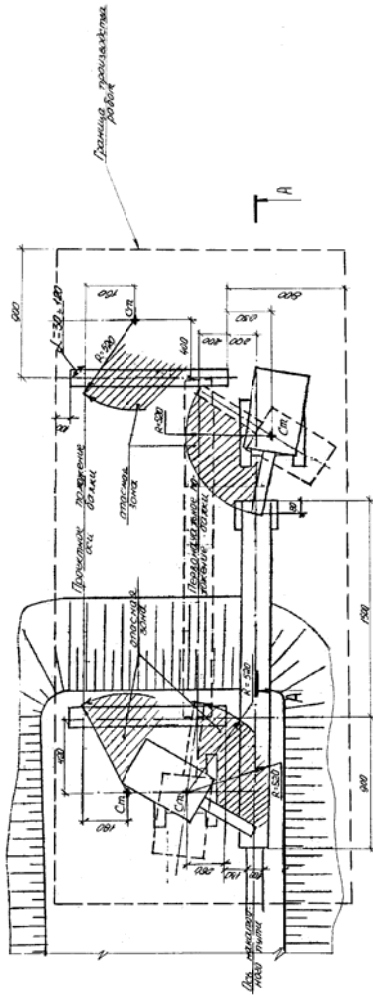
Монтаж балок крайних пролетов длиной 24 м двумя кранами, установленными в разных уровнях с использованием инвентарных подмостей
